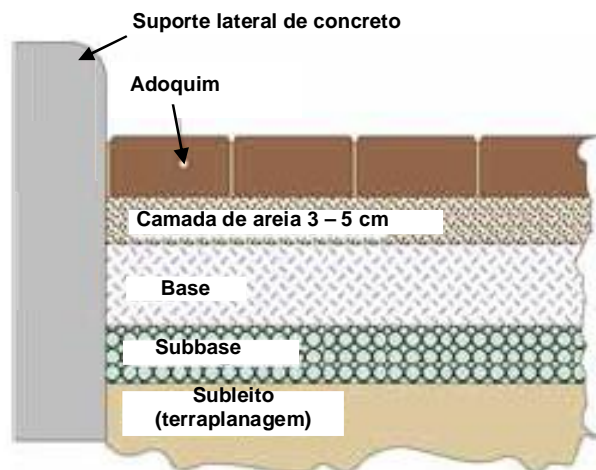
Estrutura típica de pavimentos intertravados flexíveis. Fonte: Adaptado de MALPESA (2008).
